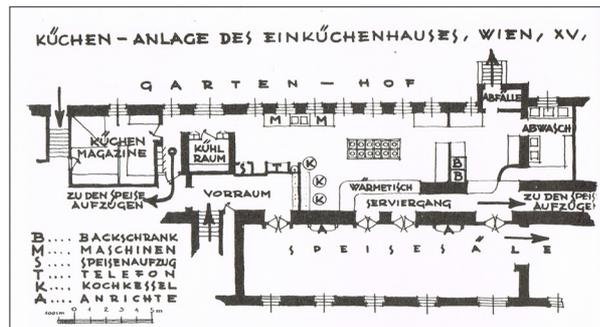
Grundriss Zentralküche und Speisesaal
